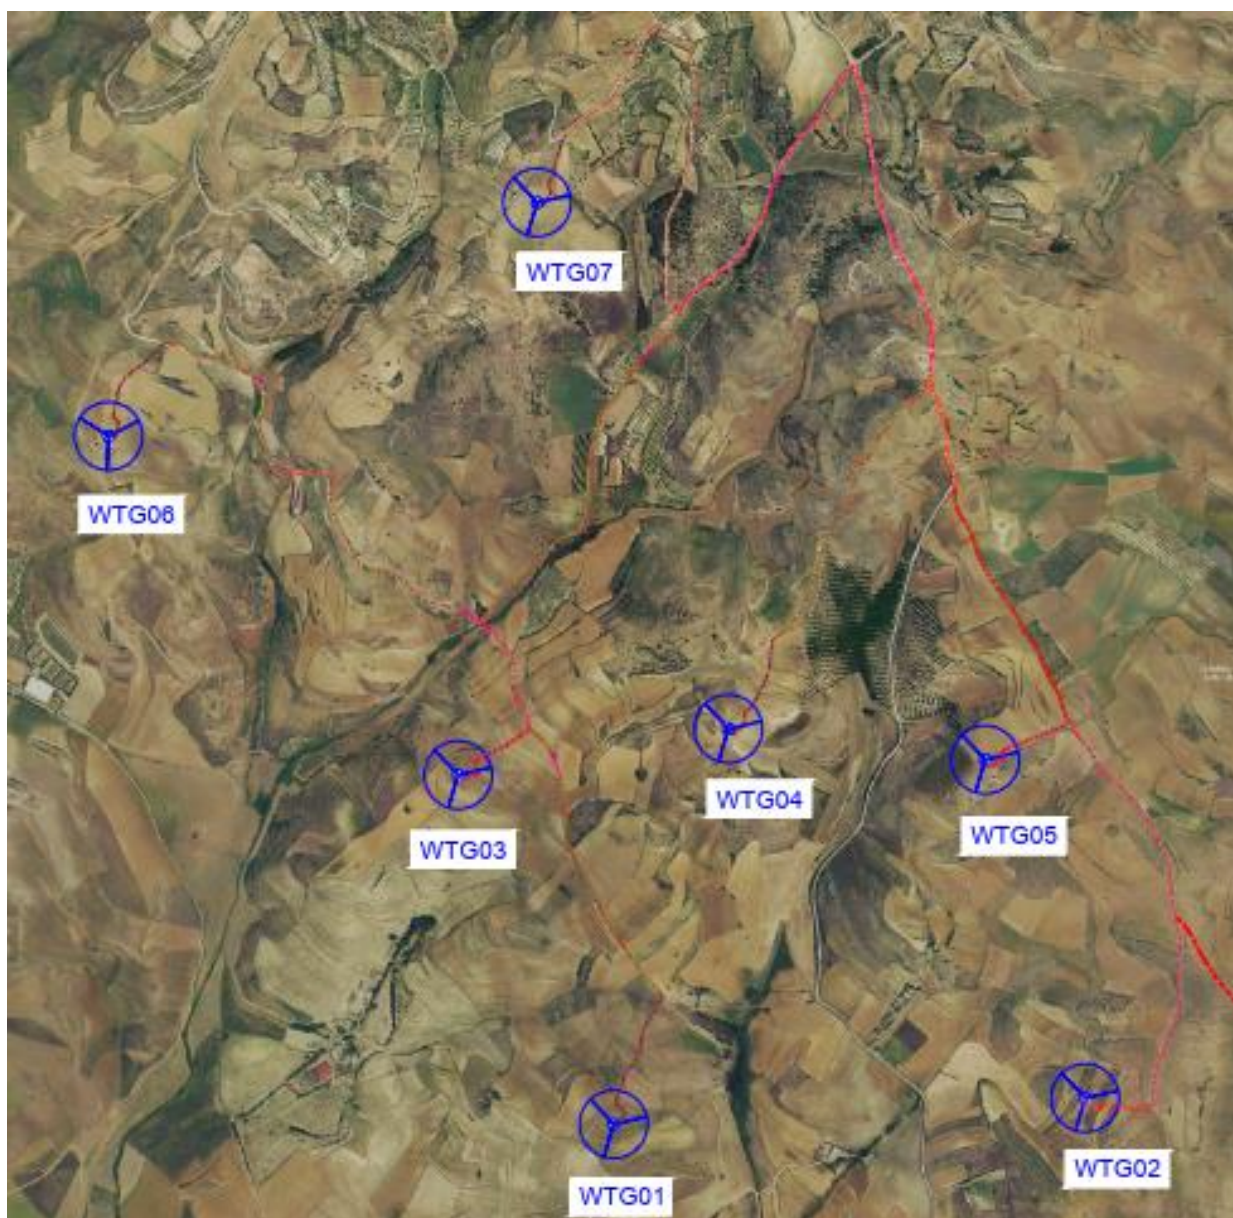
Layout della rete MT su ortofoto - impianto eolico
